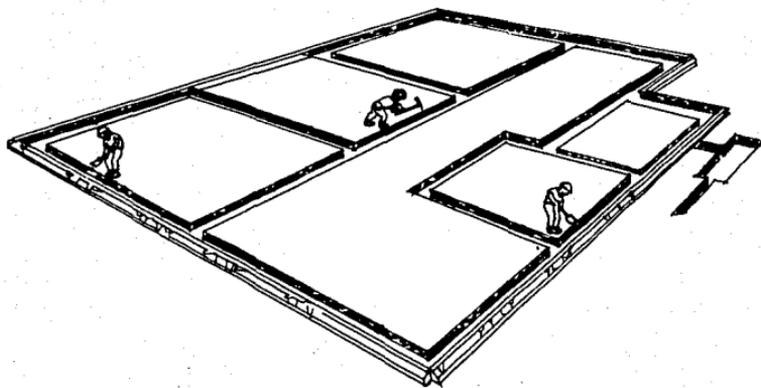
ARMADO ESTRUCTURAL DE LOSA DE CIMENTACION
